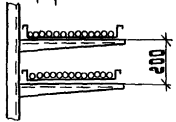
Силовые кабели сечением до 16 мм<sup>2</sup> и контрольные кабели (прокладка в пучках)
